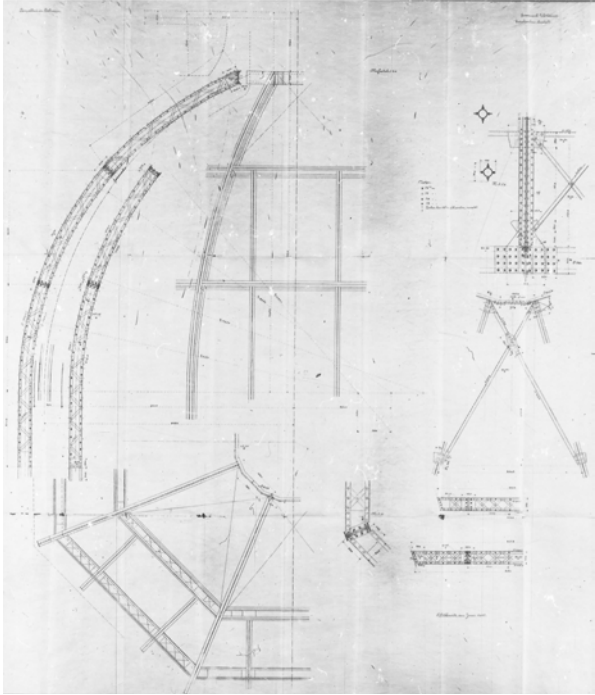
Stahlkonstruktion Kuppel Detail 03
